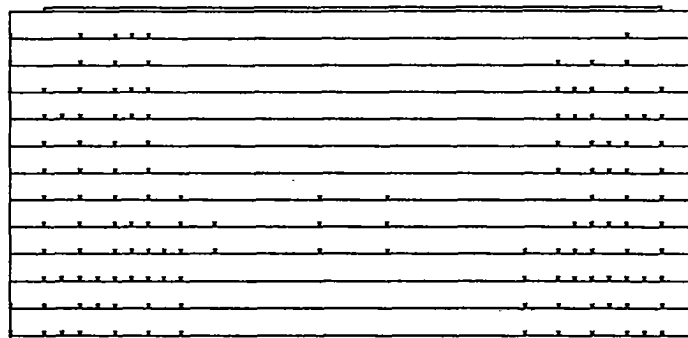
poutre PV-1 [ROUSSEL]
